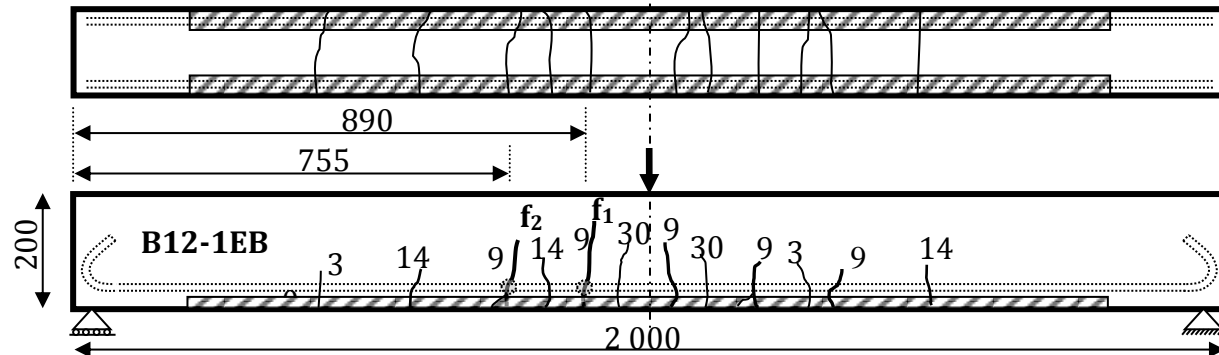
Cartes des fissurations de la poutre B12-1EB au niveau de pré-chargement de 13.5 kN.m.
